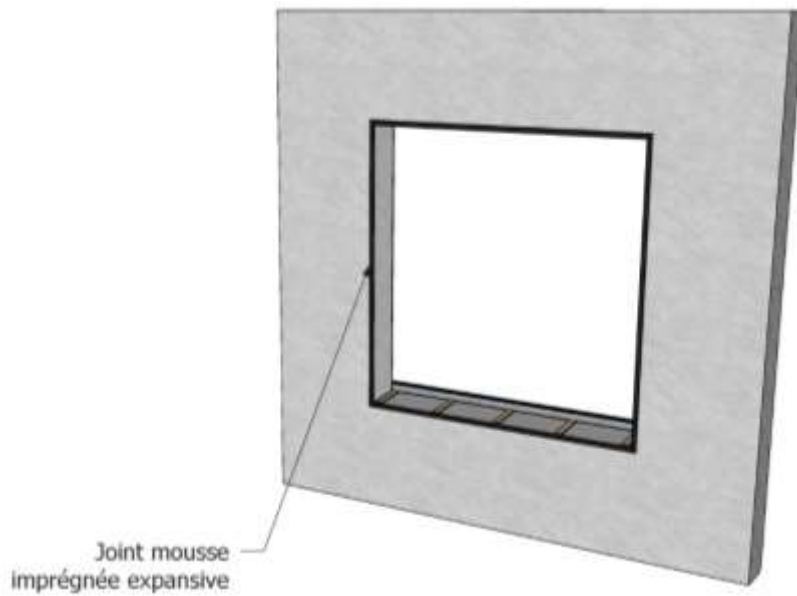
Pose de d'un joint mousse imprégnée expansive sur la face extérieure des panneaux TimberRoc
